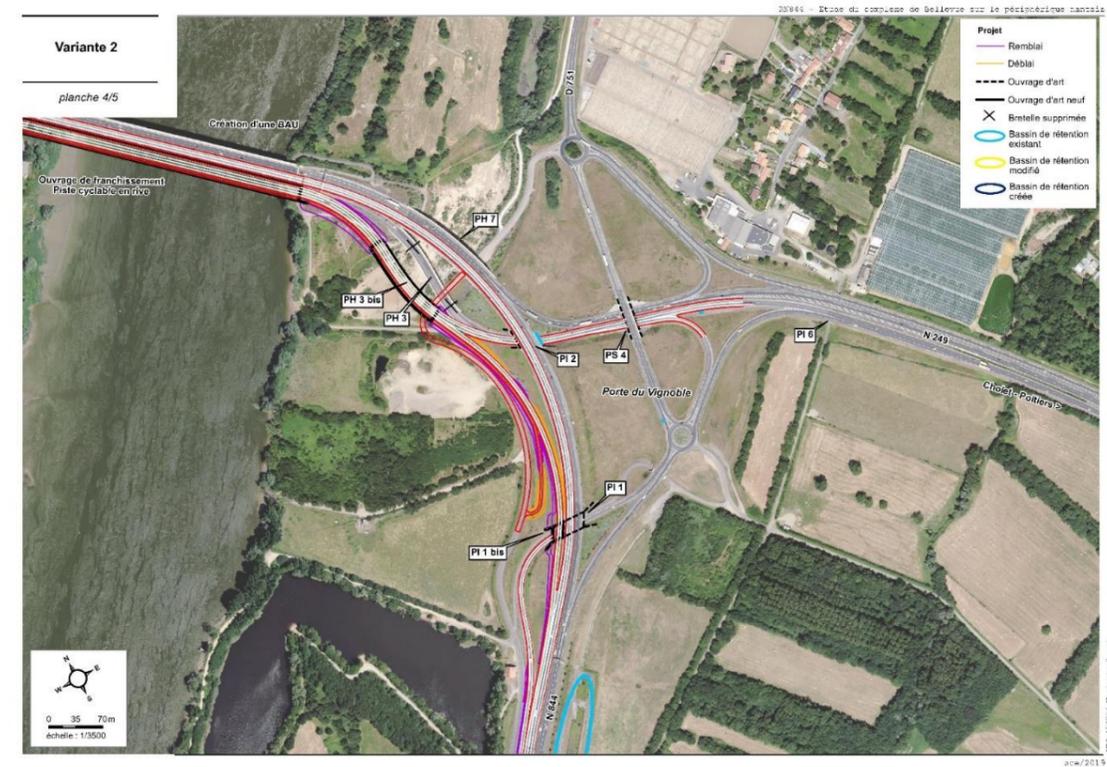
Plan de la variante 2 au droit de la Porte du Vignoble
